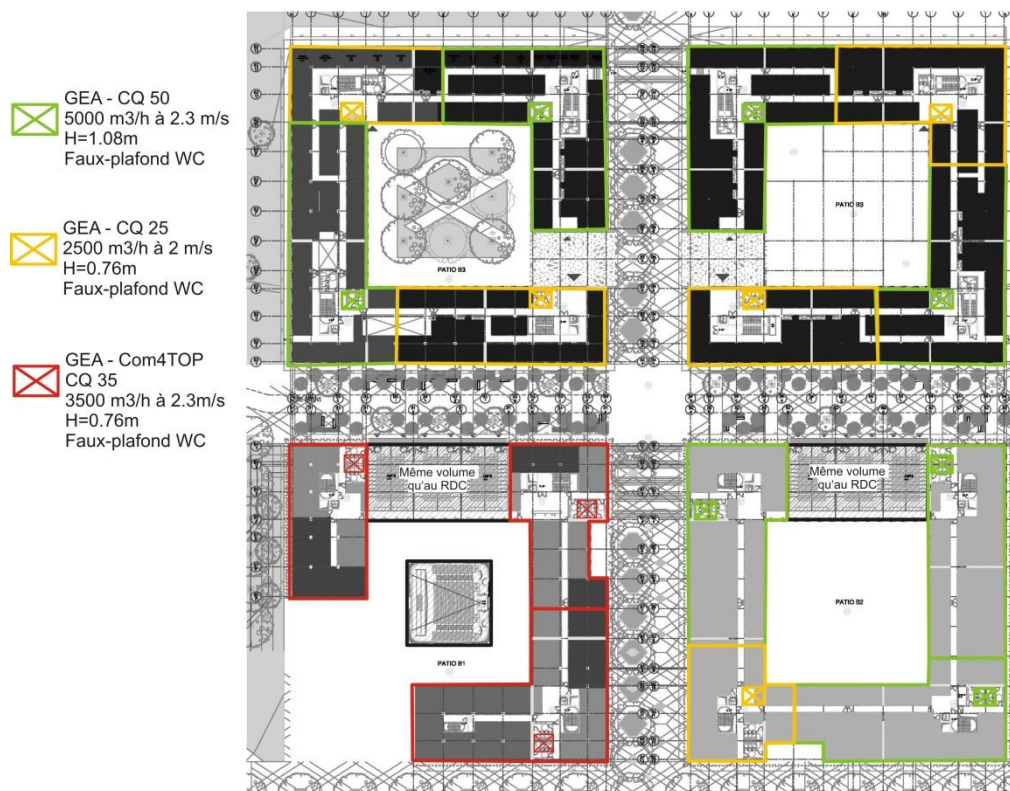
Plan d'implantation des CTA – B1B2 R1 – B3B4 RDC
